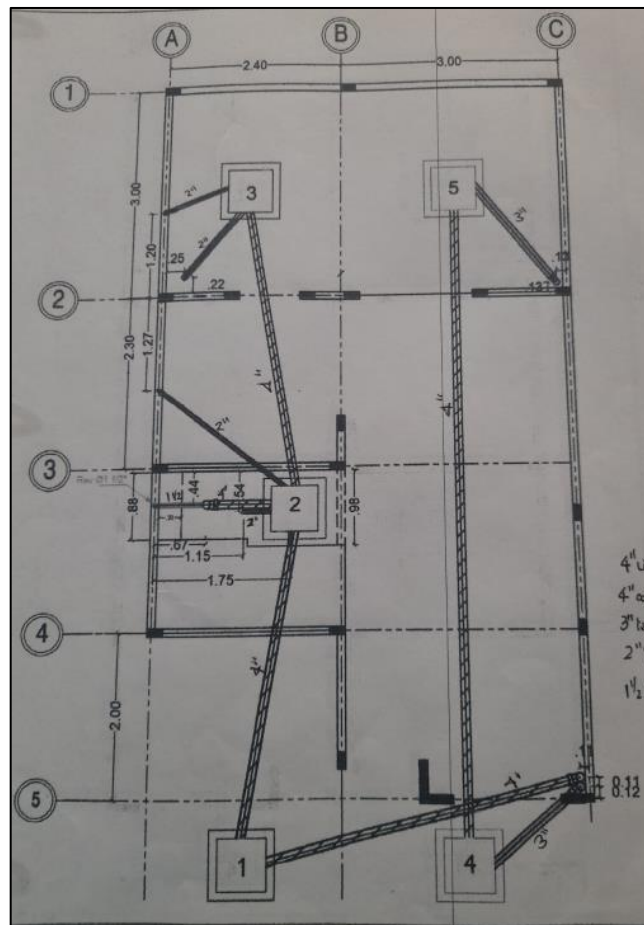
Plano cajas de inspección e instalaciones sanitarias primer piso. Fuente: Propia.
